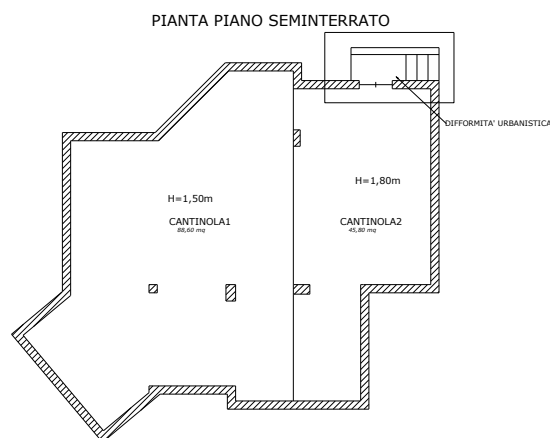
planimetria delle difformità urbanistiche del piano seminterrato della villa
